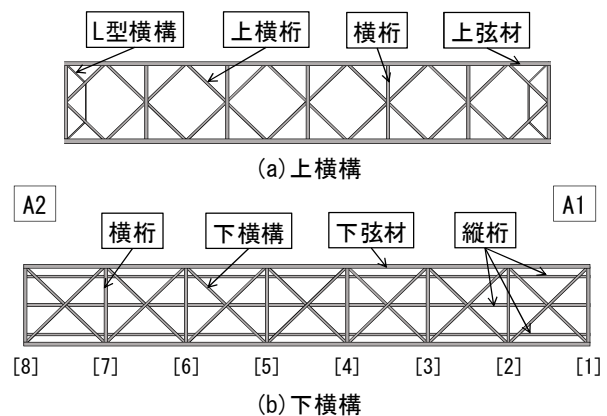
平面図 (上図 : 上横構配置, 下図 : 下横構配置)
